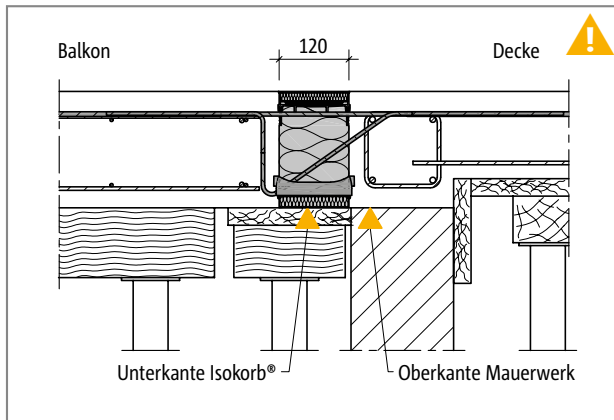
Schöck Isokorb® XT Typ K: Ortbetonbalkon mit höhenversetzter Decke auf Mauerwerkswand
